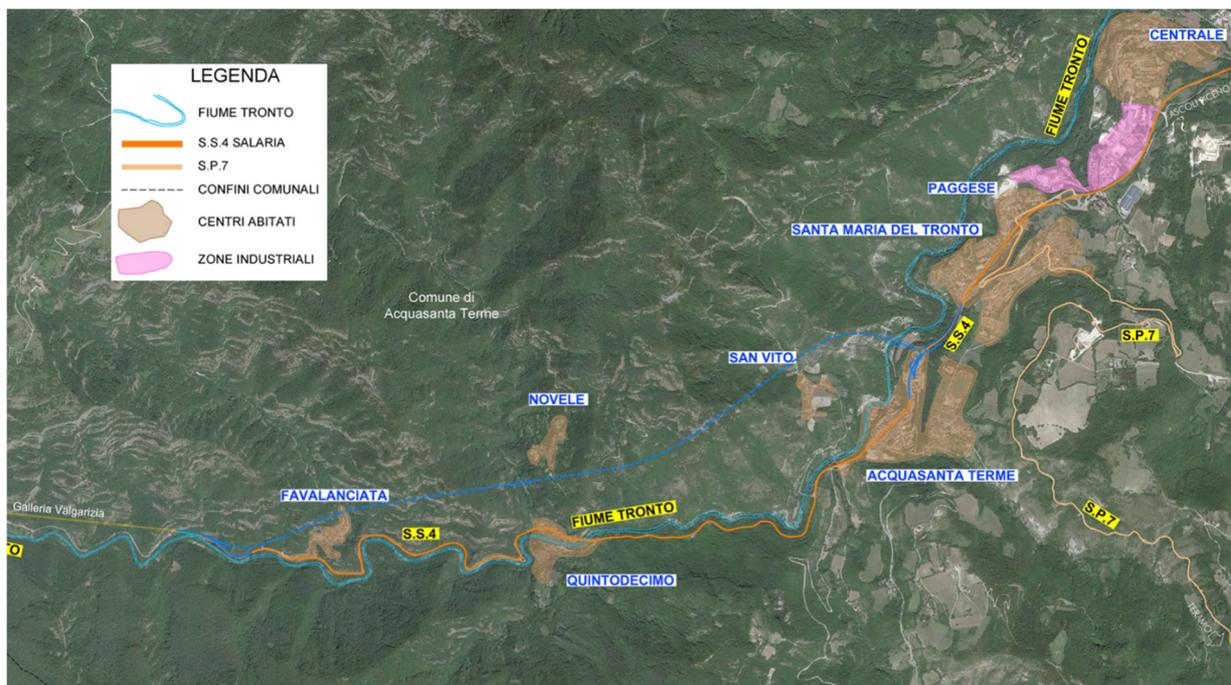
Alternativa 2 - Planimetria su fotomosaico
